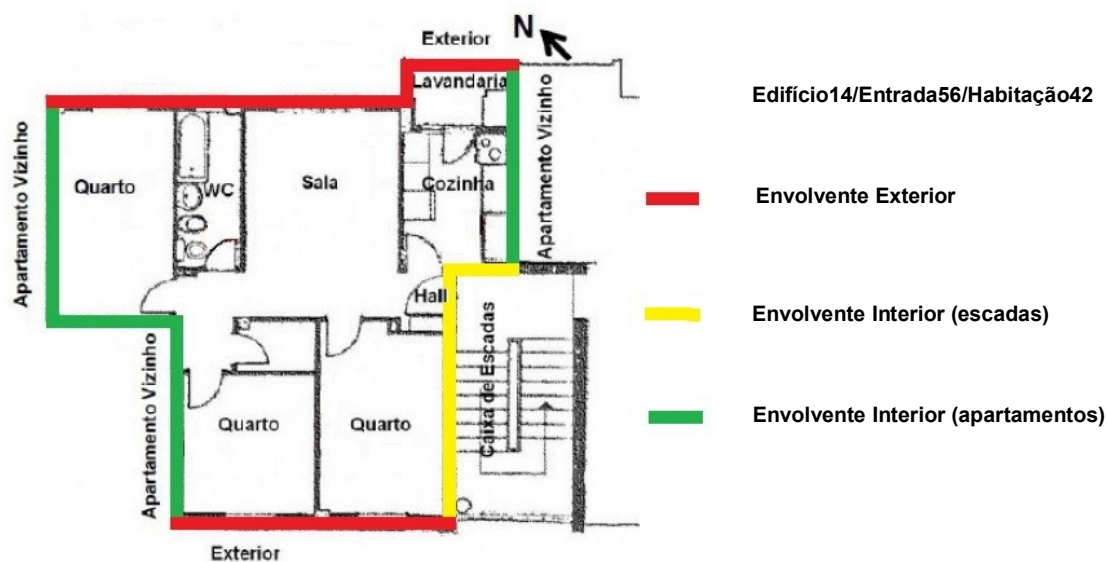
Marcação da envolvente do Apartamento-Tipo em planta
